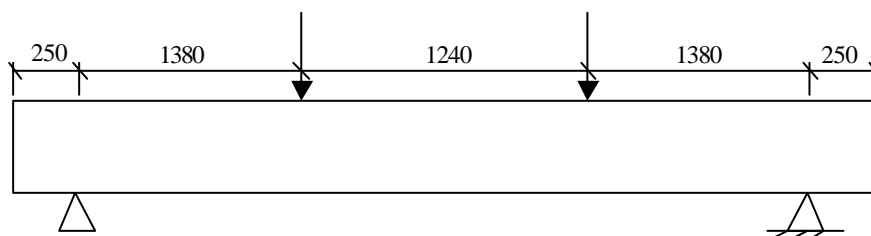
Geometria e carregamento das vigas ensaiadas por Araújo (2000).
